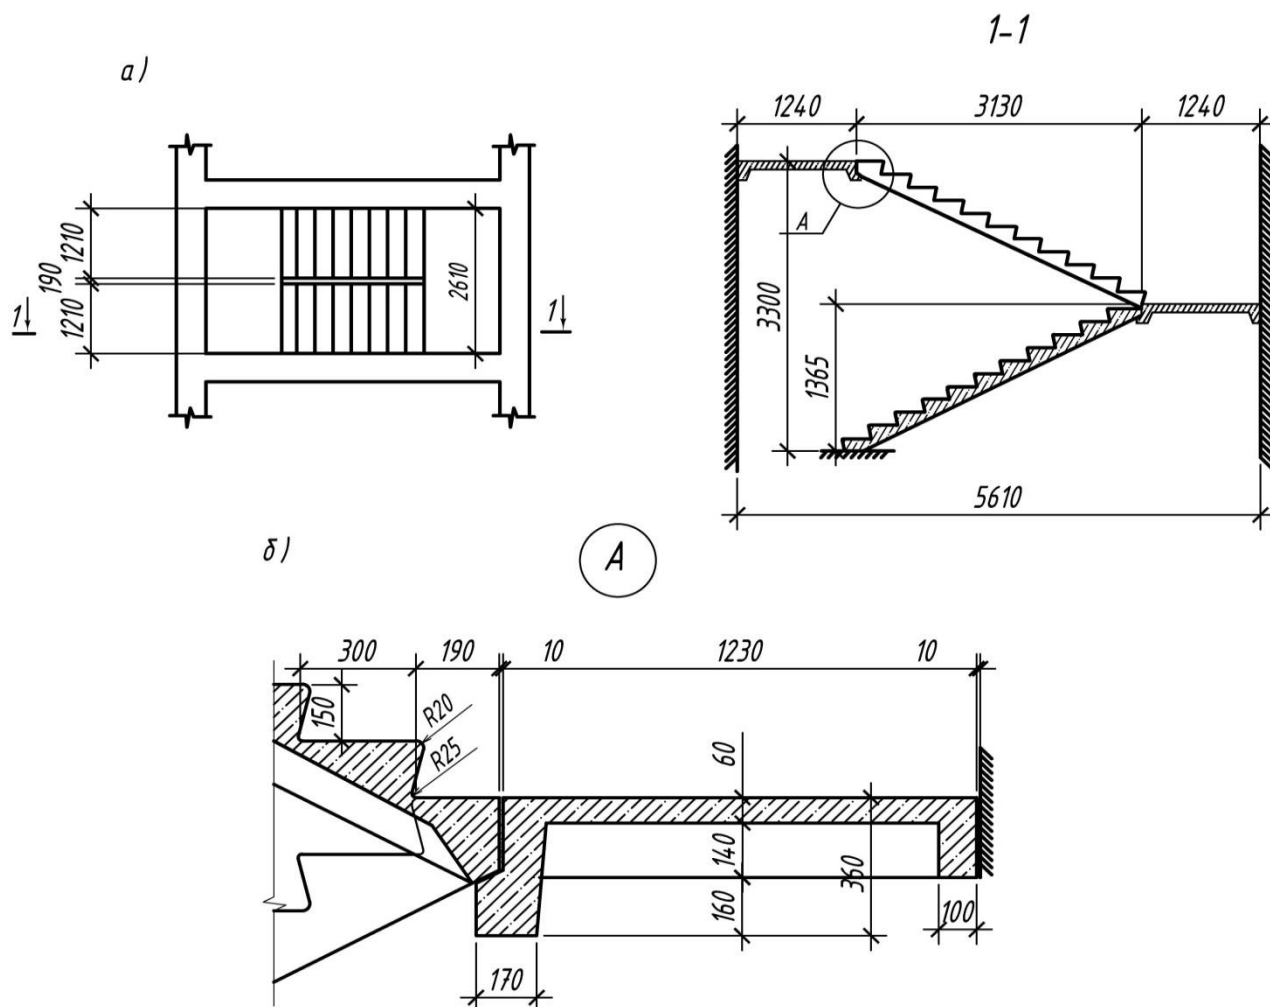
Детали сборной железобетонной двухмаршевой лестницы:
